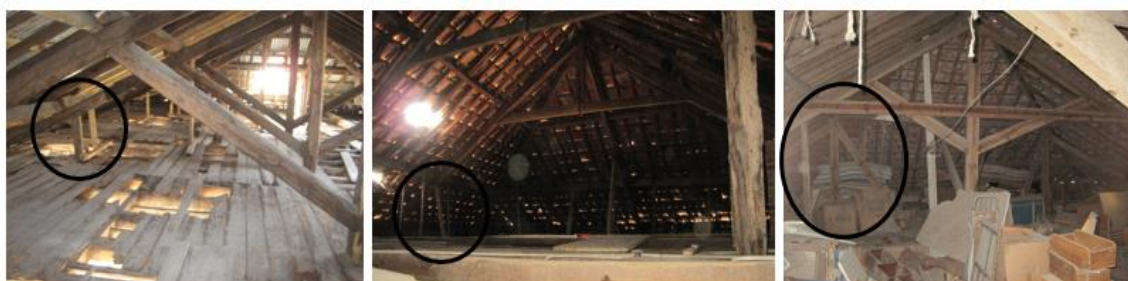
Possíveis aplicações da técnica em coberturas do CHL
